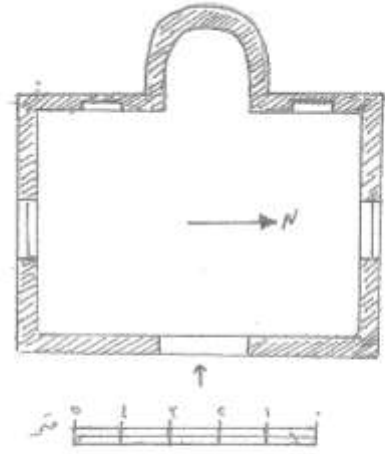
مسقط أفقي لمسجد عيسى الظاهري
